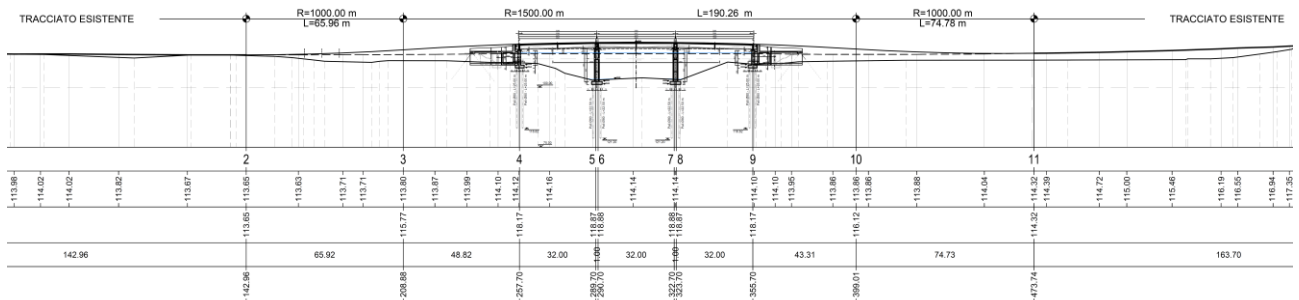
Profilo longitudinale stato di progetto soluzione prescelta
